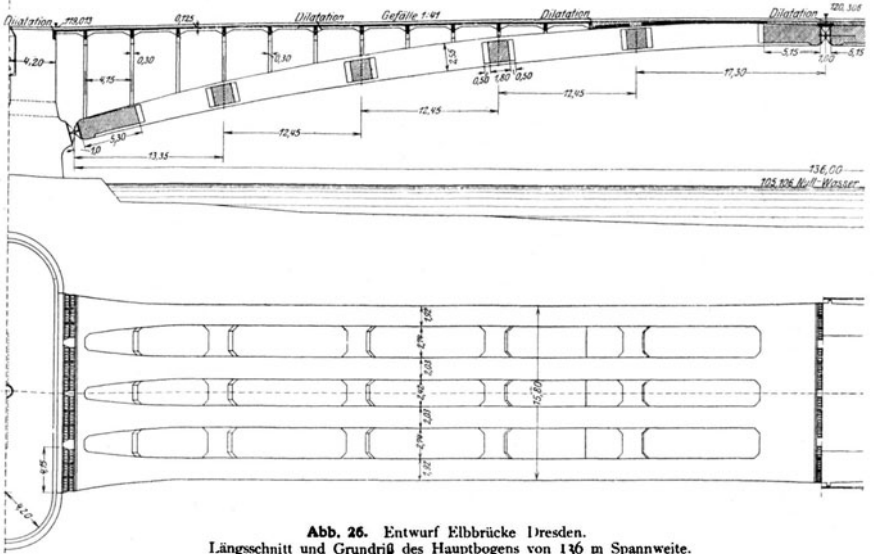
Entwurf Elbbrücke Dresden. Längsschnitt und Grundriß des Hauptbogens von 136 m Spannweite.
